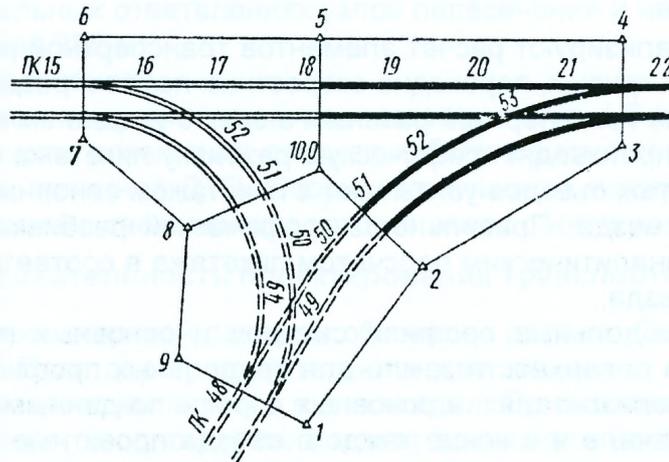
Схема деления транспортной развязки для составления разбивочных чертежей
